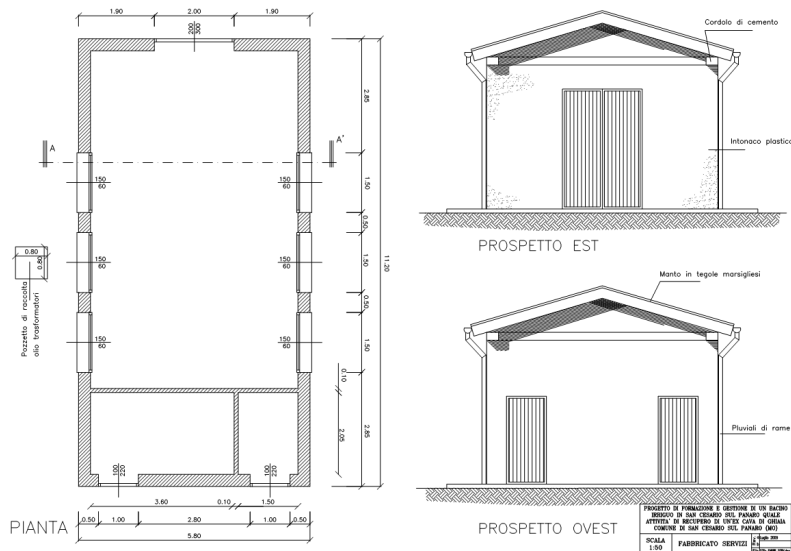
Pianta e prospetto del fabbricato servizi (Enel, trasformatori, quadri elettrici, compressori).
